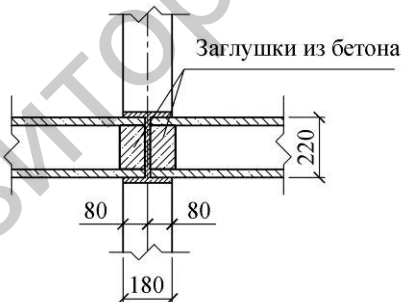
Заглушки из бетона в местах опирания панелей
